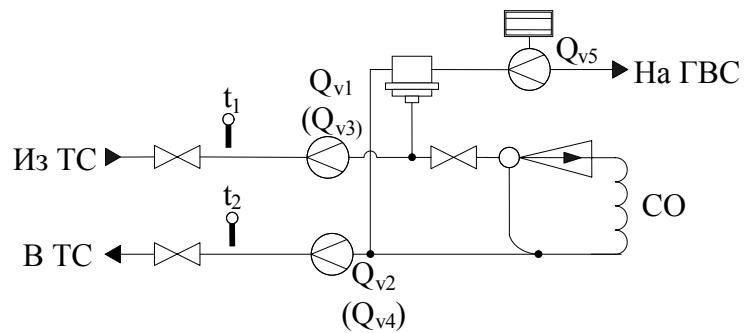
Двухтрубная открытая система теплоснабжения с разбором на ГВС, с контрольным расходомером на подающем трубопроводе ГВС
